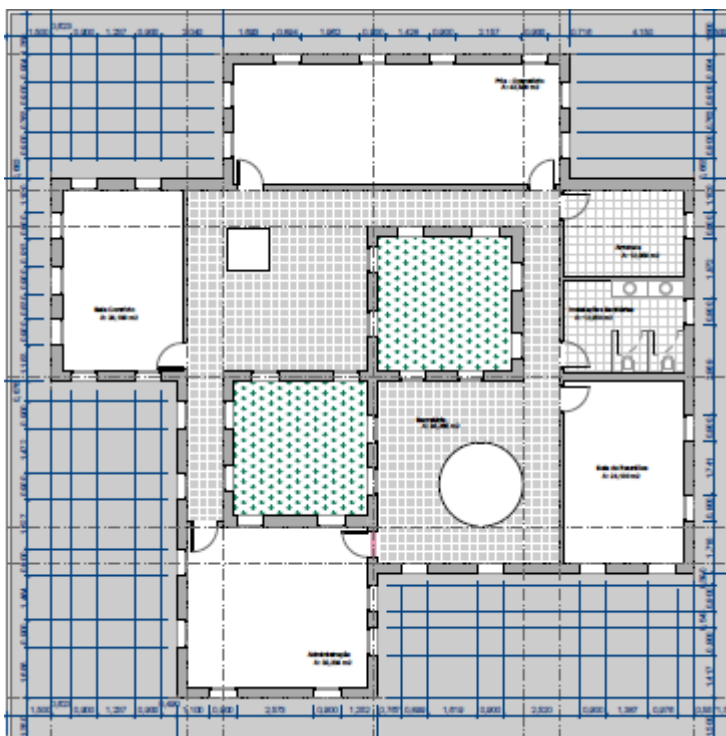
Planta do Piso 1 (Fonte: Projecto de Arquitectura)
